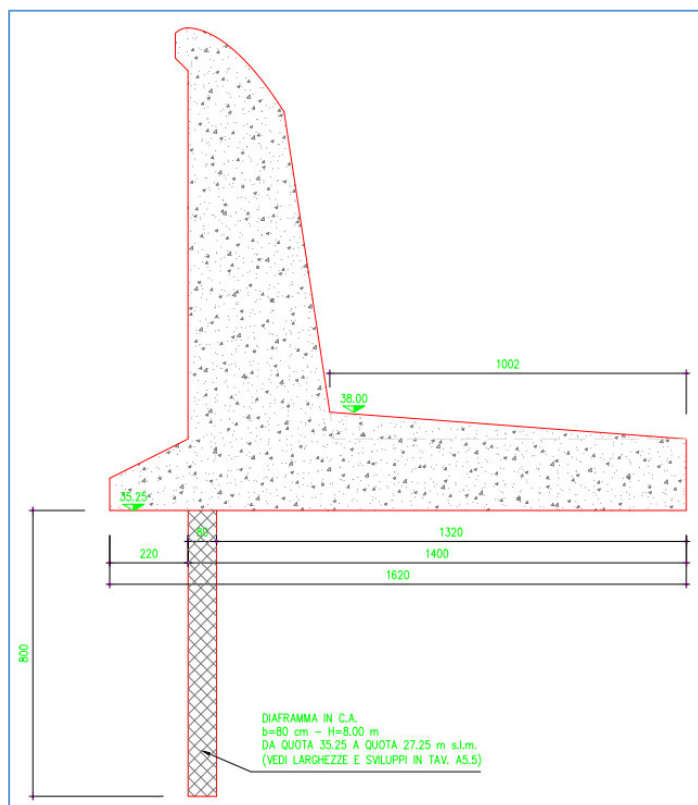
Adeguamento manufatto di regolazione – Sezione tipo con taglione in fondazione
